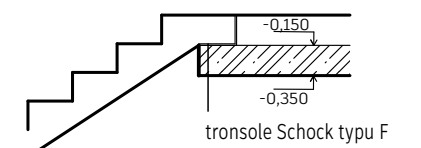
DETAIL NAPOJENÍ SCHODIŠŤE NA ZÁKLAD 1:50
